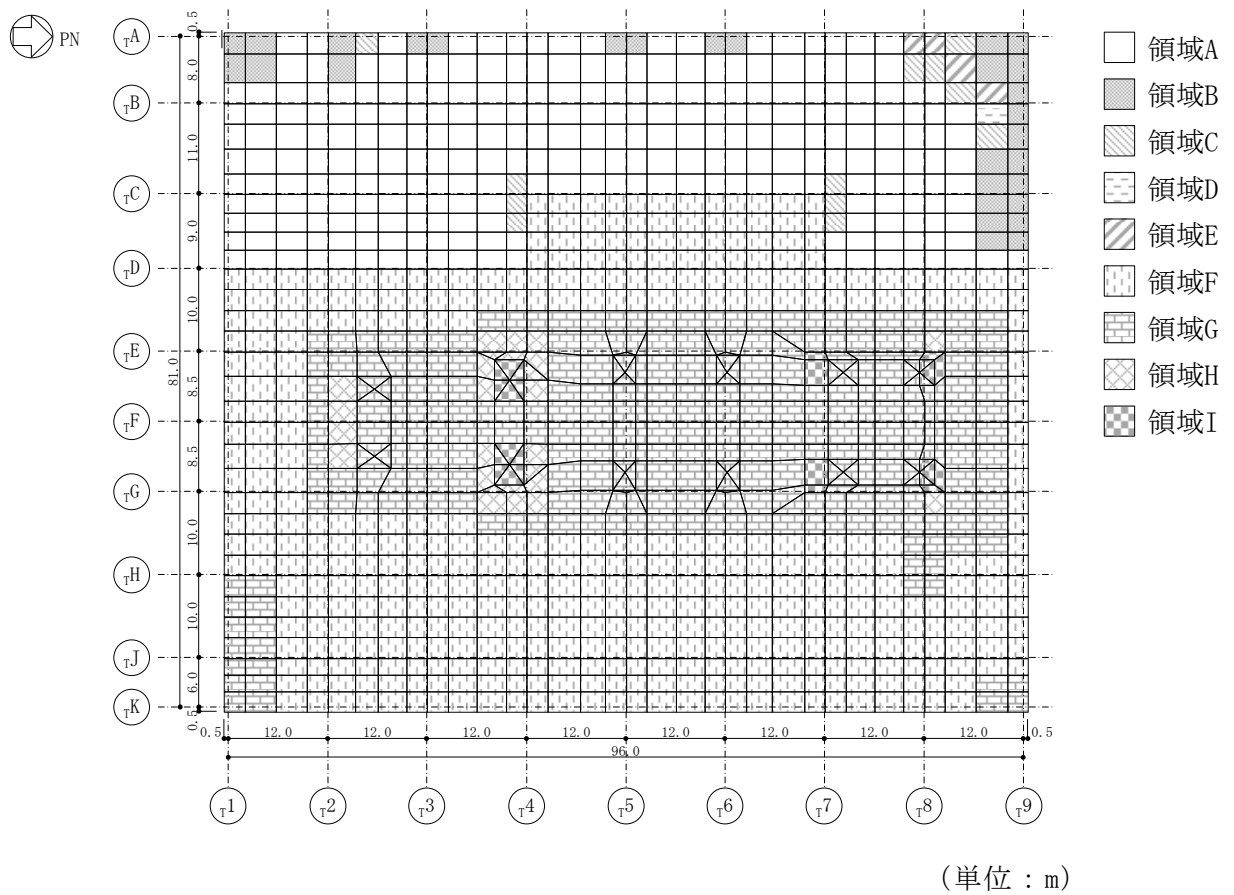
基礎スラブの配筋領域図 (NS 方向, 下ば筋)
